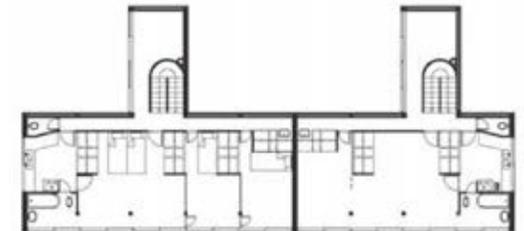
Planta de la Casa Doble de Le Corbusier en la Weissenhofsiedlung (Stuttgart, Werkbund 1927)
